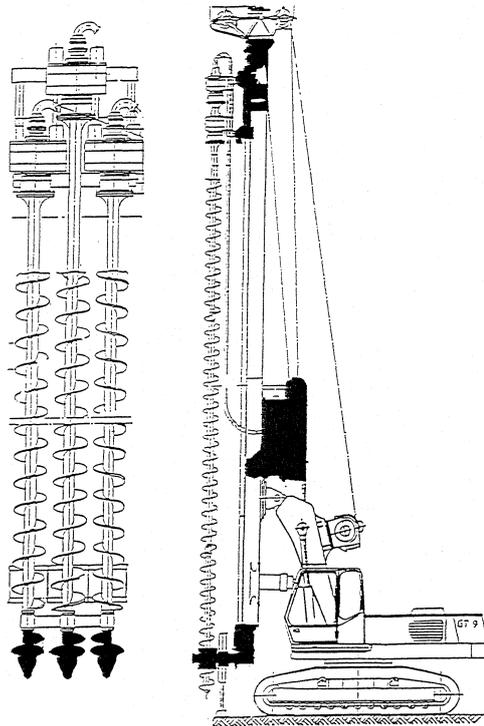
MIP Bohrgerät mit Dreierschnecke [1]
